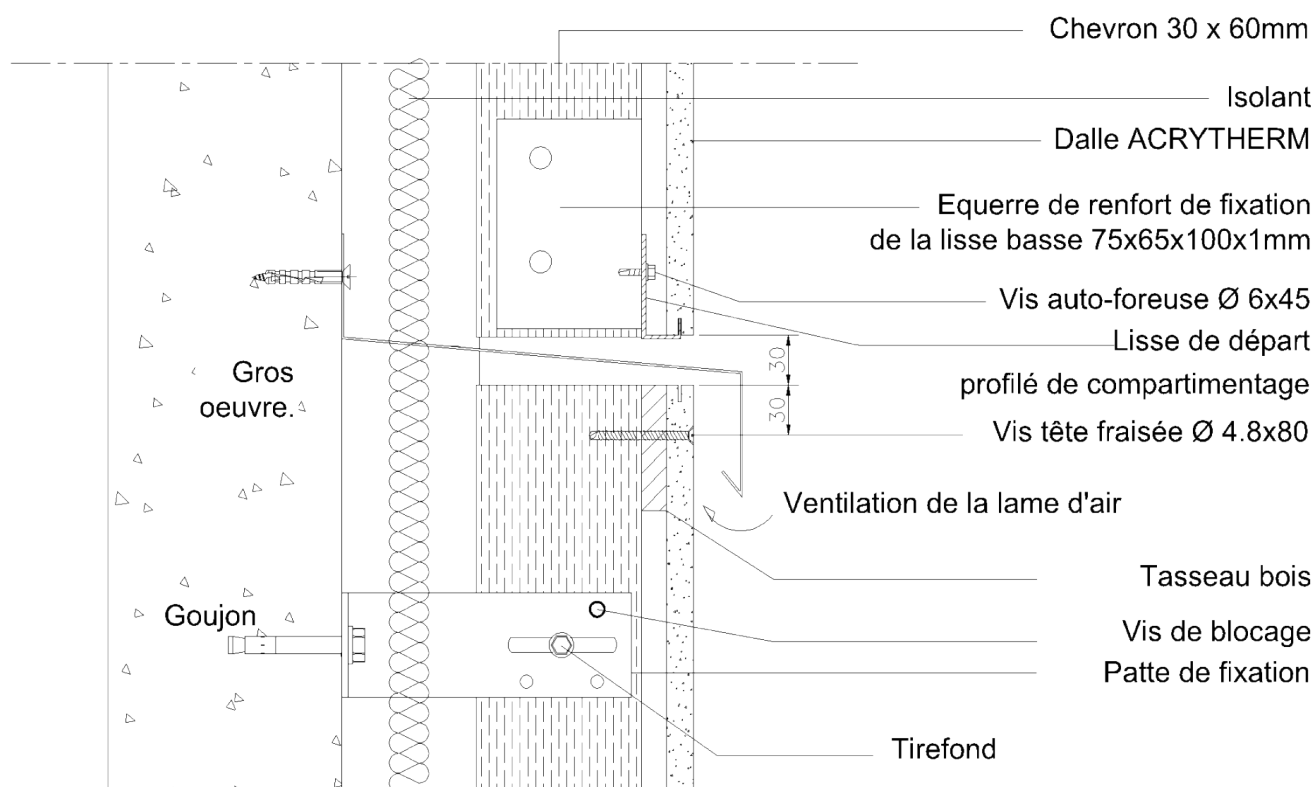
Coupe verticale – Fractionnement de la lame d'air
